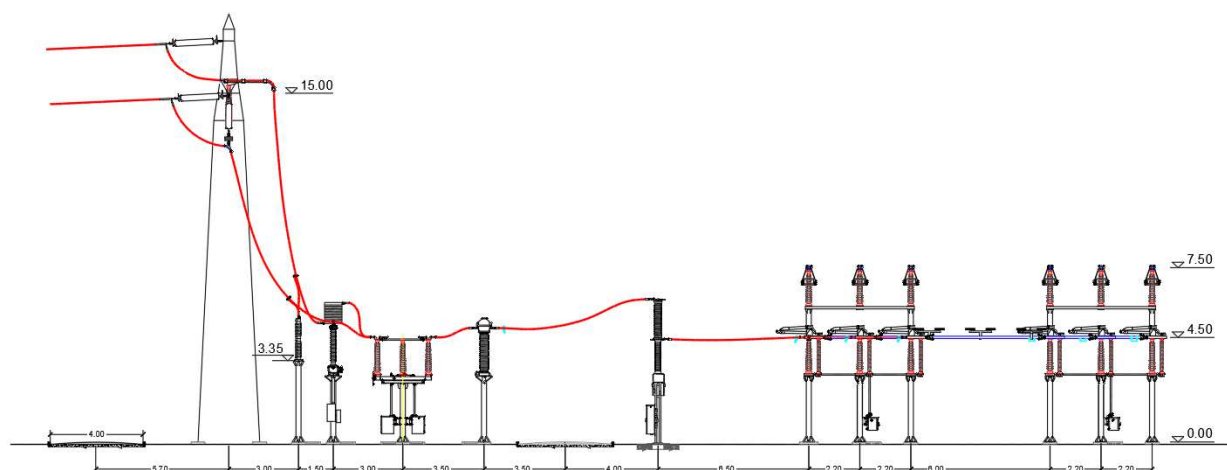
sezione futuro stallo di arrivo in Stazione Elettrica RTN
